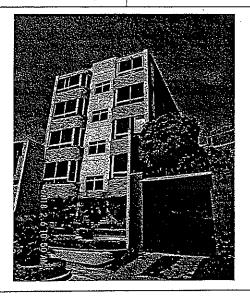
FACHADA LATERAL IZQ Foto 4 FACHADA LATERAL DERECH
